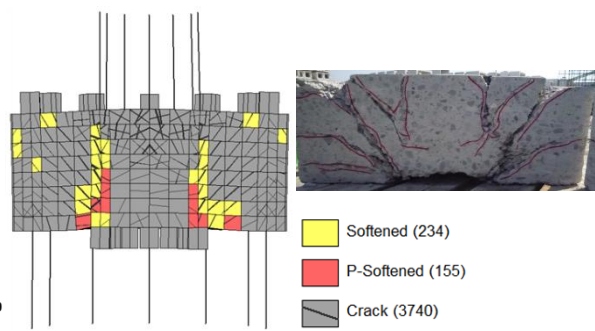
試験体 A のひび割れ，変形と実験の写真
